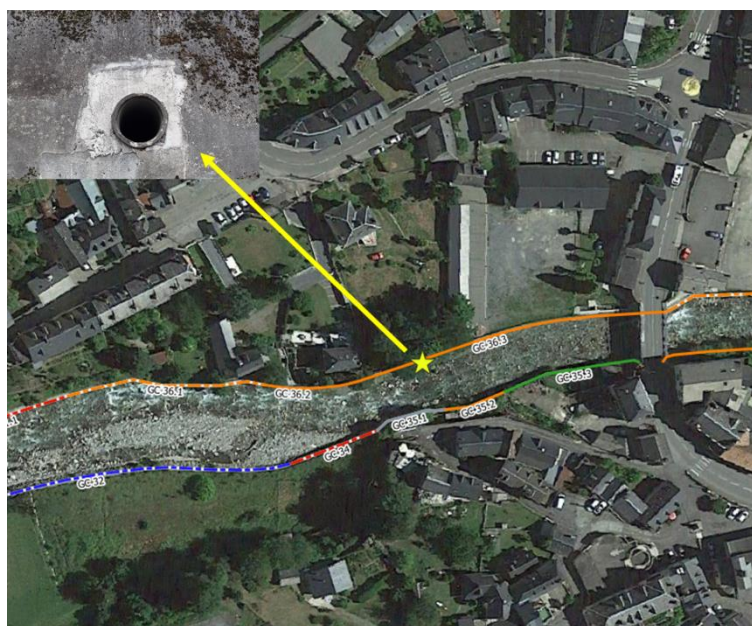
Localisation de l'ouvrage traversant (D=500 mm) du tronçon GC 36.3
